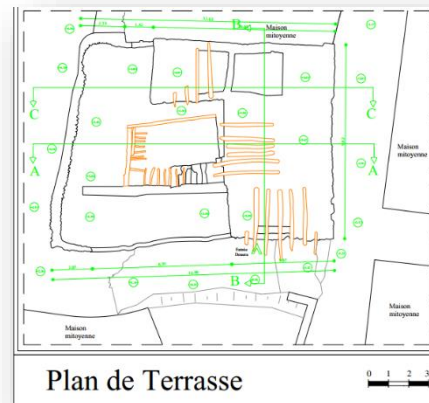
Plan de toiture de la maison 10 qu'il faut reprendre. Source : Auteure. 2022.
